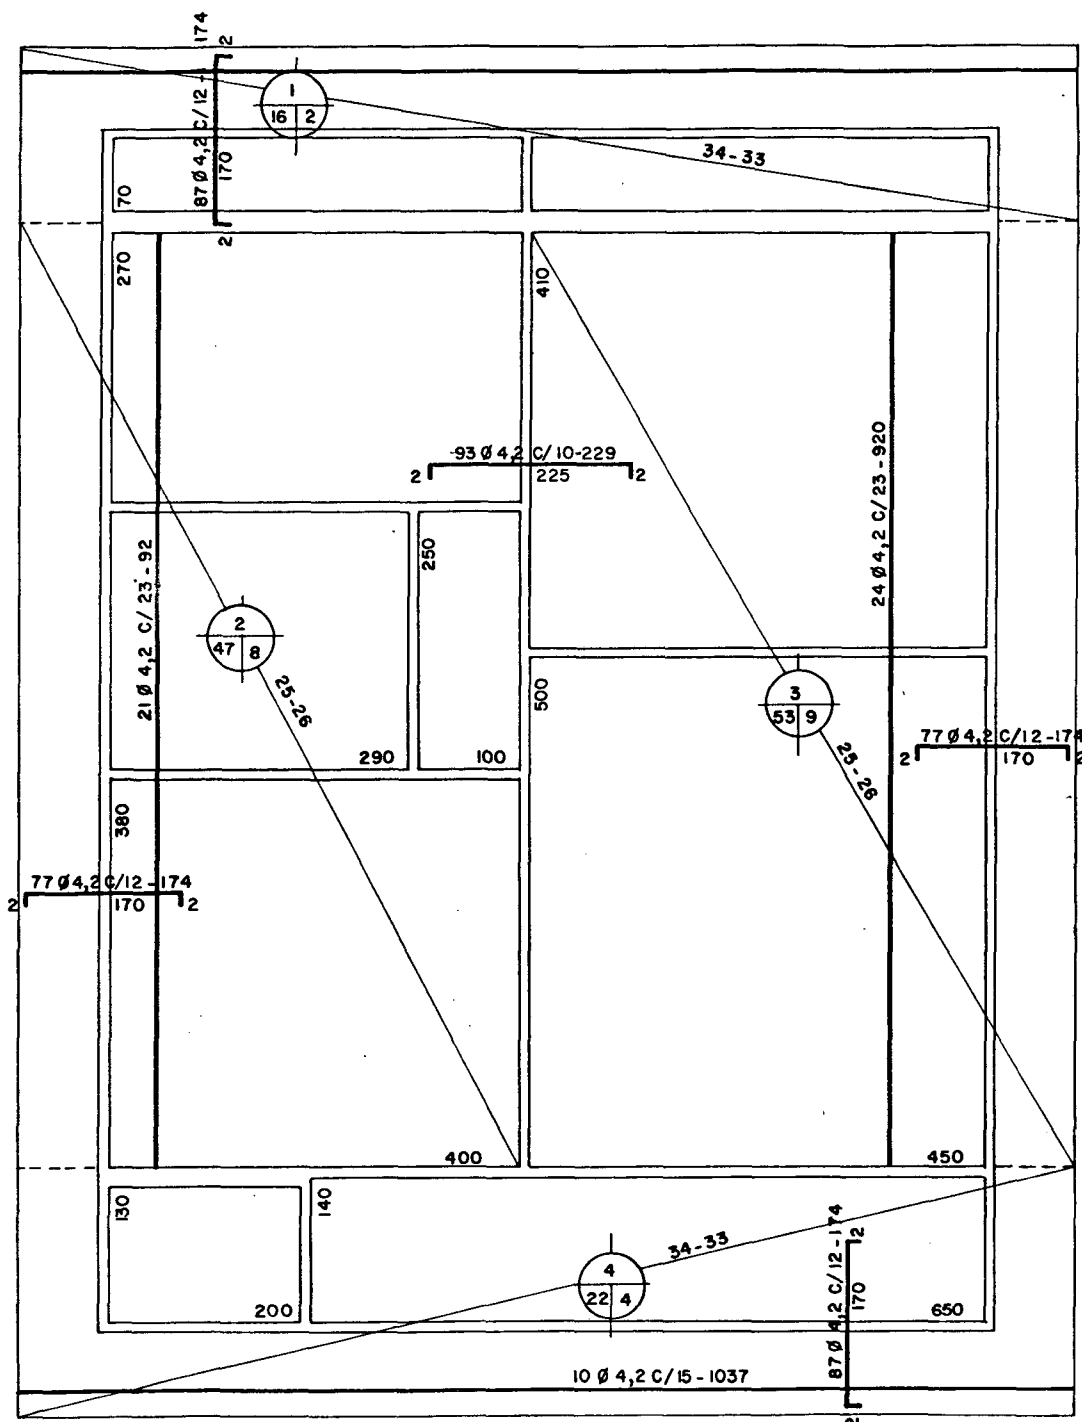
PROJETO DE LAJE PRÉ-MOLDADA
